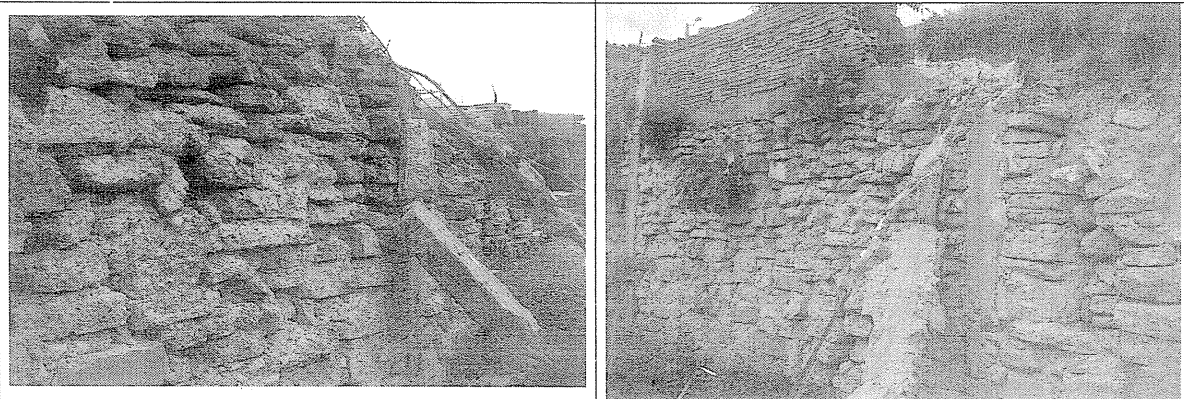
Desprendimientos de elementos del muro en el extremo sur.
